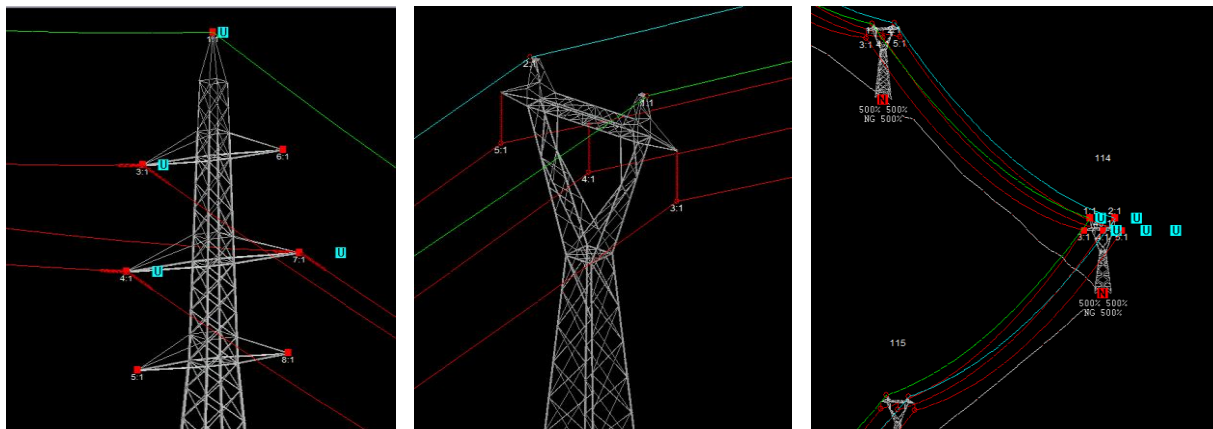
Vue en 3D et zoom sur pylônes et le câblage.
